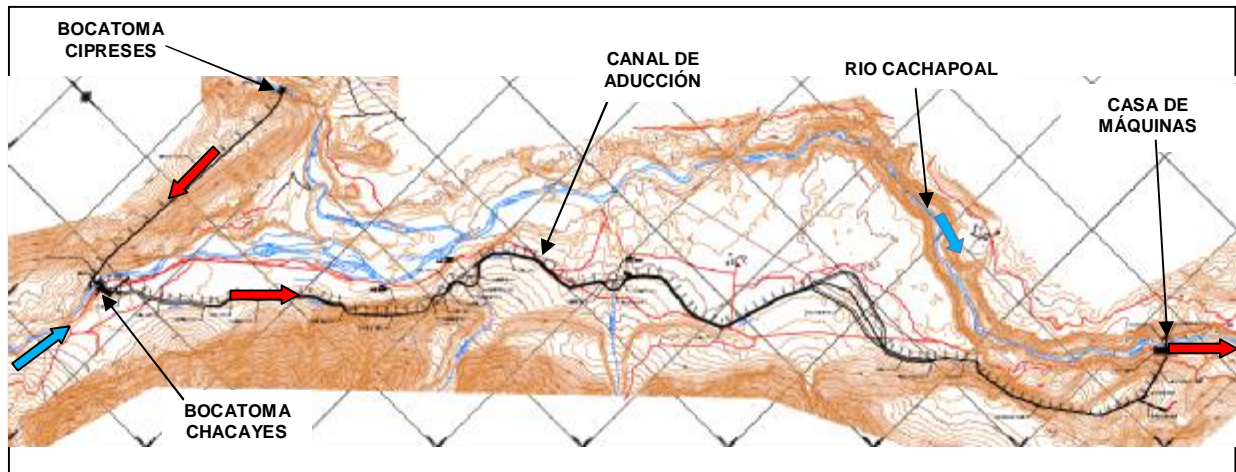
DISPOSICIÓN PROYECTO CHACAYES
